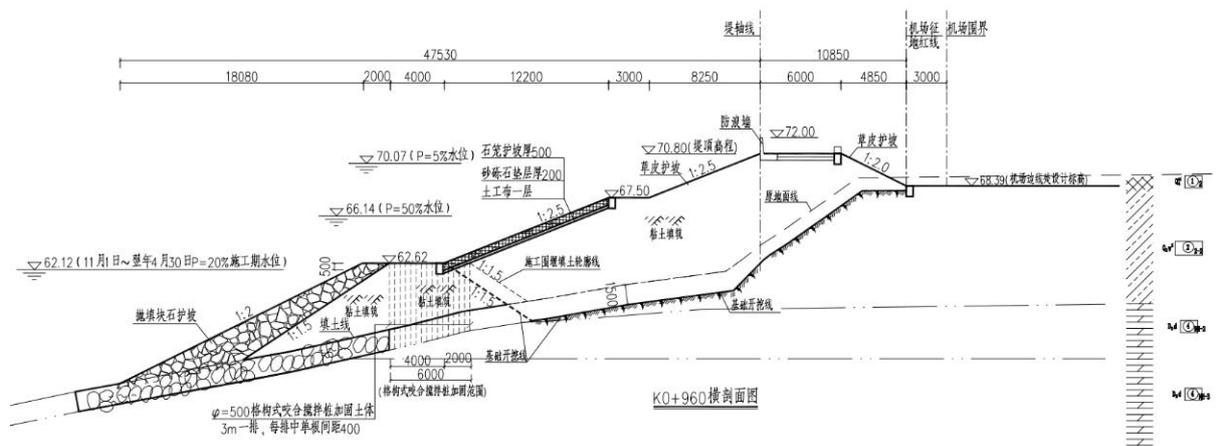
桩号 K0+960 土堤+防浪墙堤型剖面图
